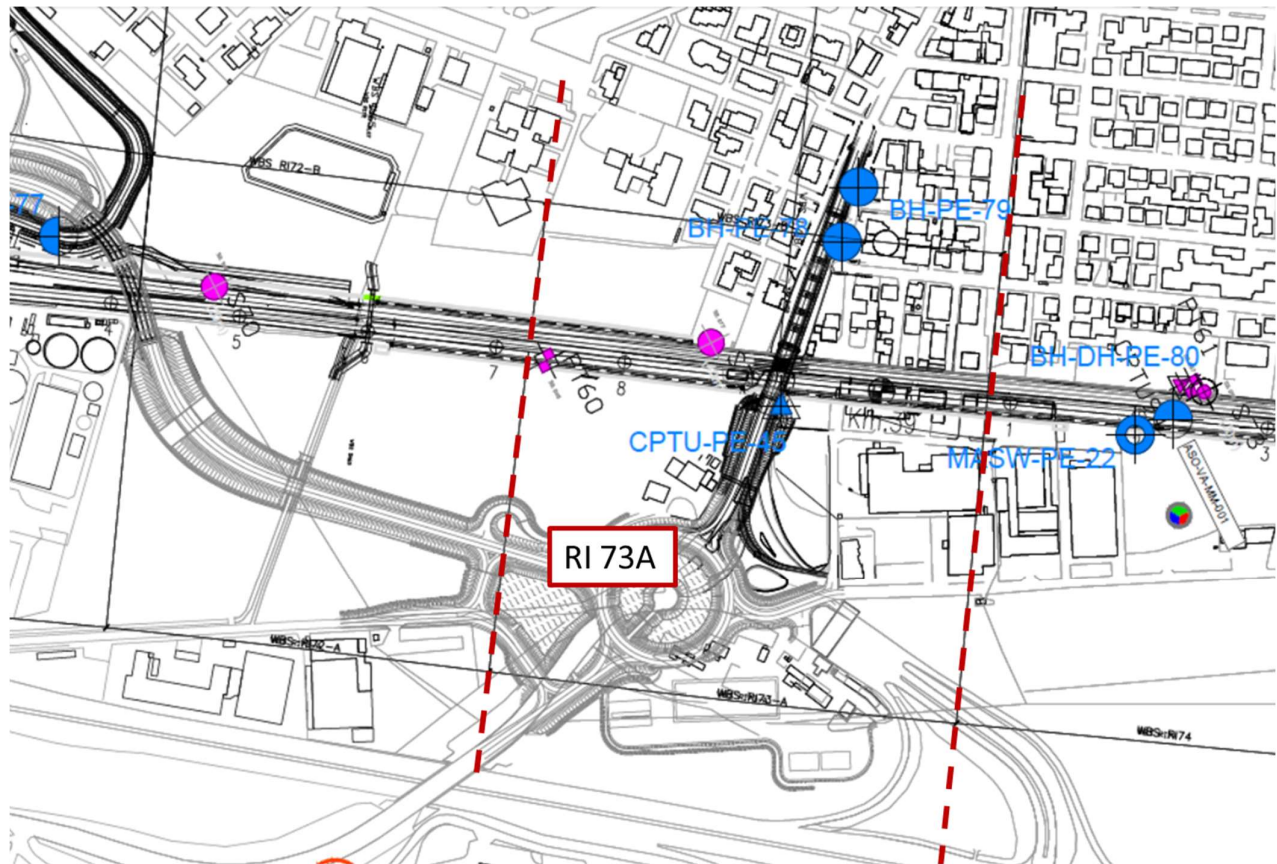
Planimetria Rilevato RI73A, estratto dalla Planimetria Generale (Doc. Rif. [3])
